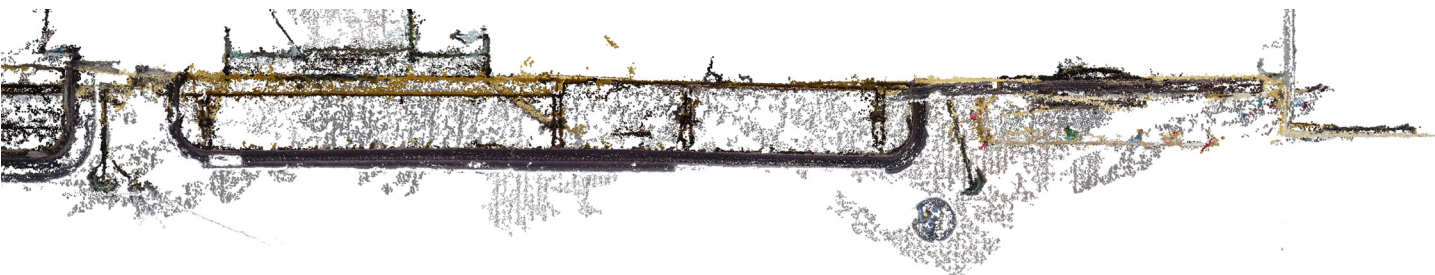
Ortoimagen, elevación del balcón de la Casona Jr. Trujillo
